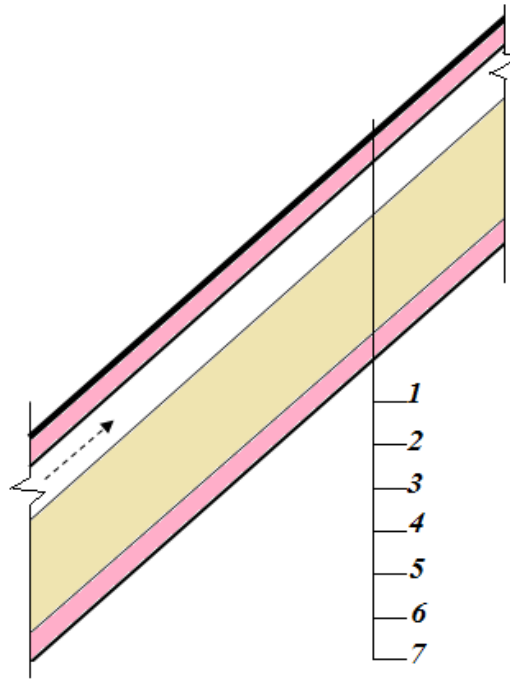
Схема скатной кровли с вентилируемым зазором:
